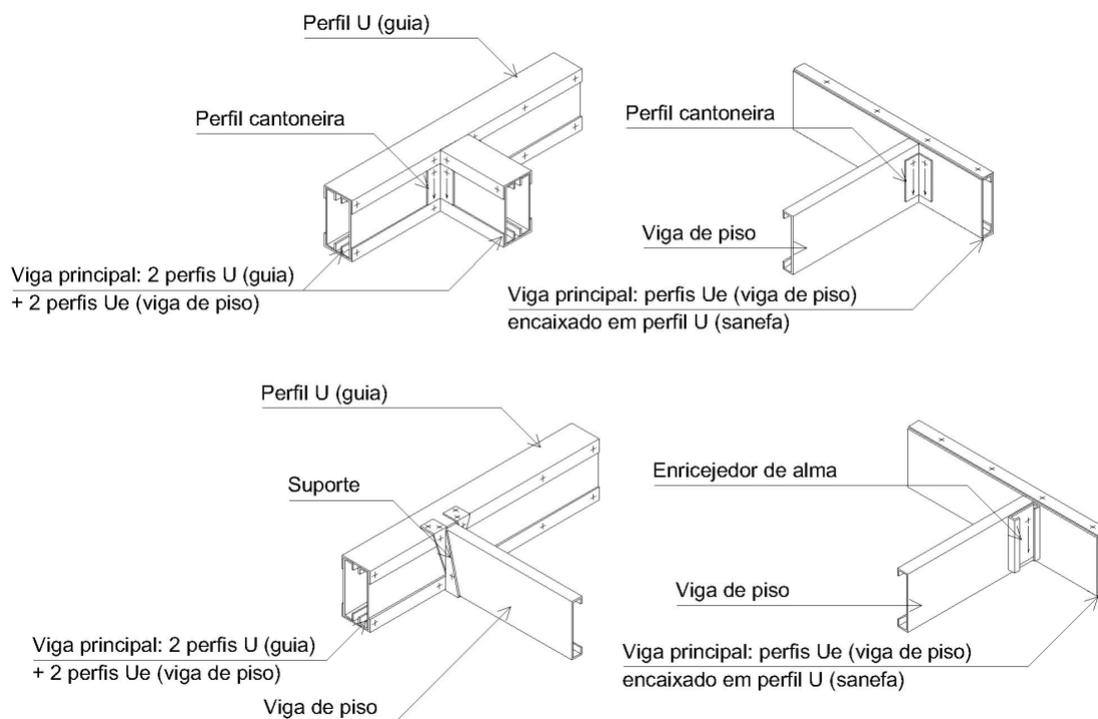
Tipos de vigas principais para apoio de vigas de piso.
